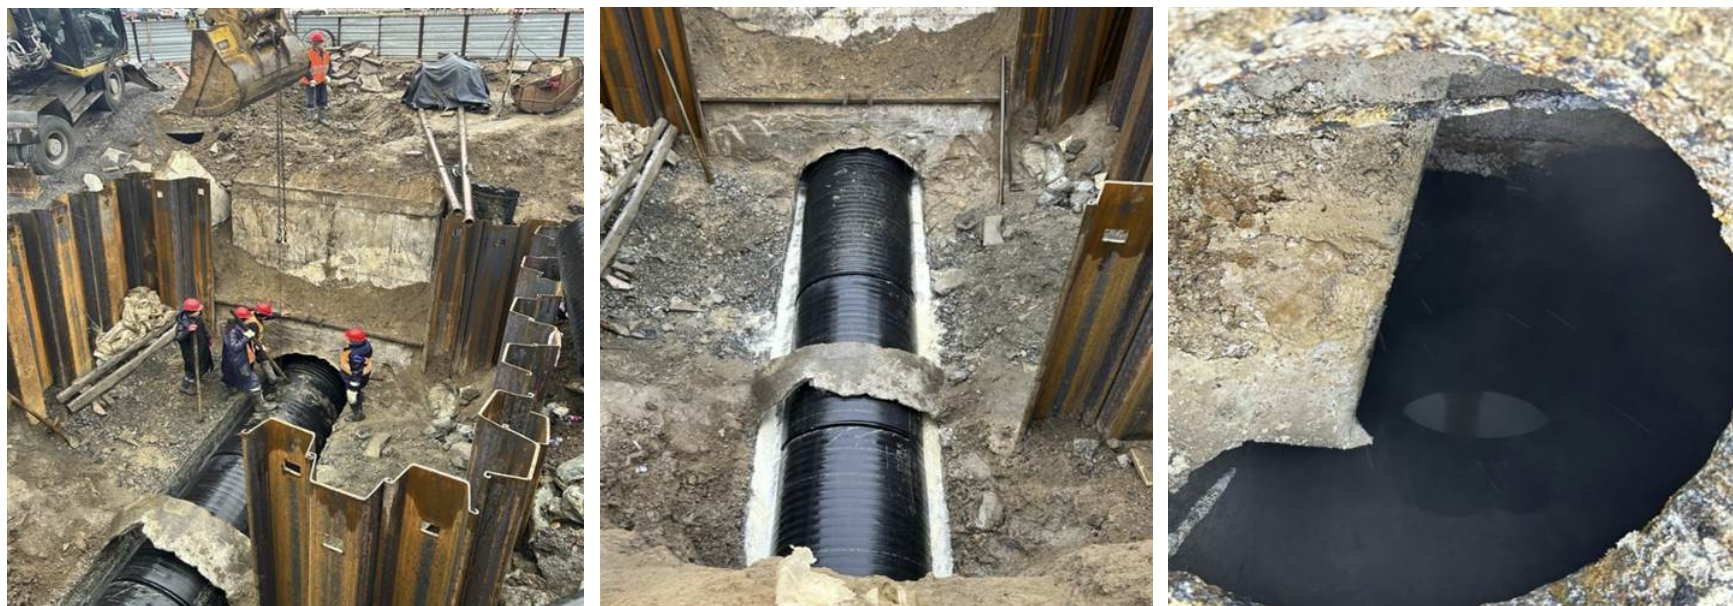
Протяжка резьбовых модулей (труб) типа СПИРОЛАЙН без кондуктора
